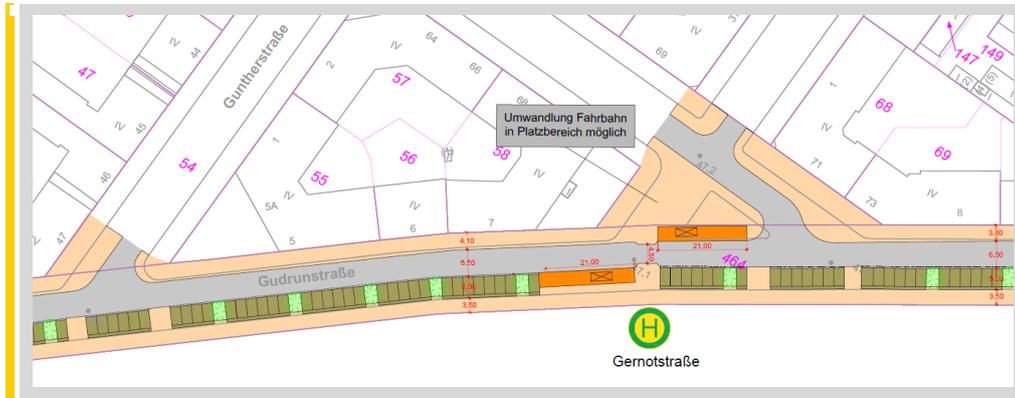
Lageplan Gudrunstraße Bereich Gernotstraße/Guntherstraße
